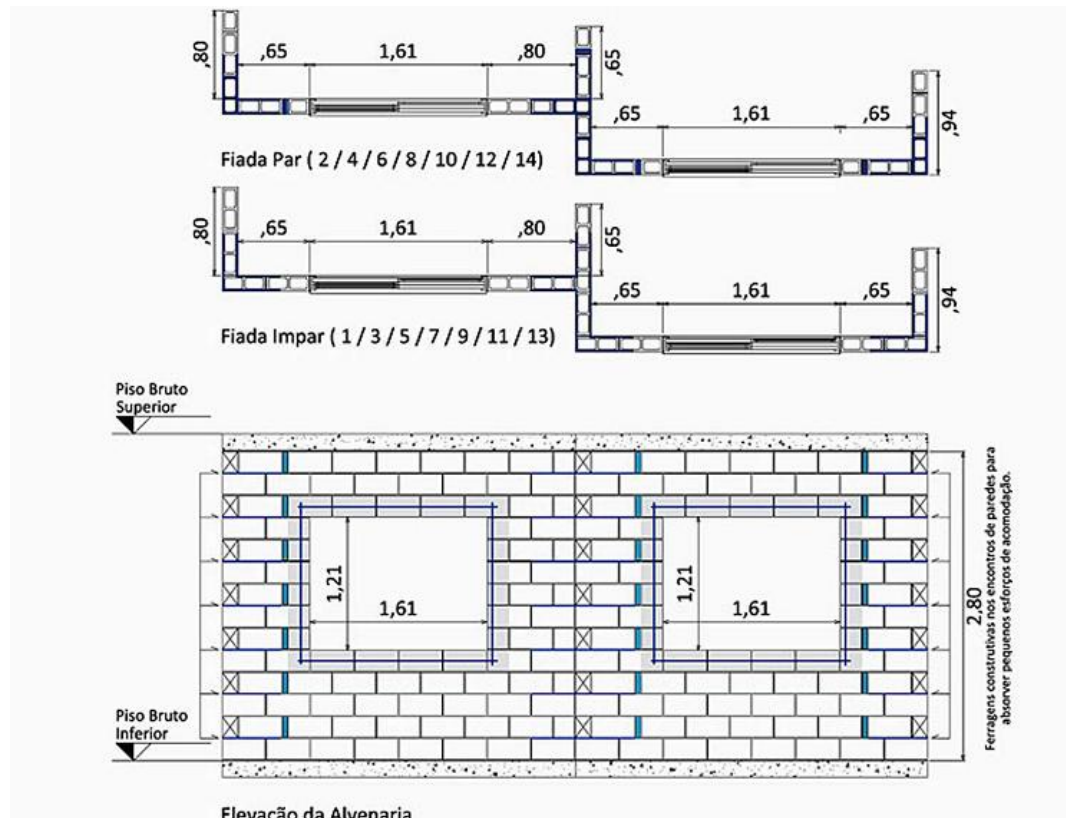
Projeto alvenaria estrutural (TAUIL, 2010)
